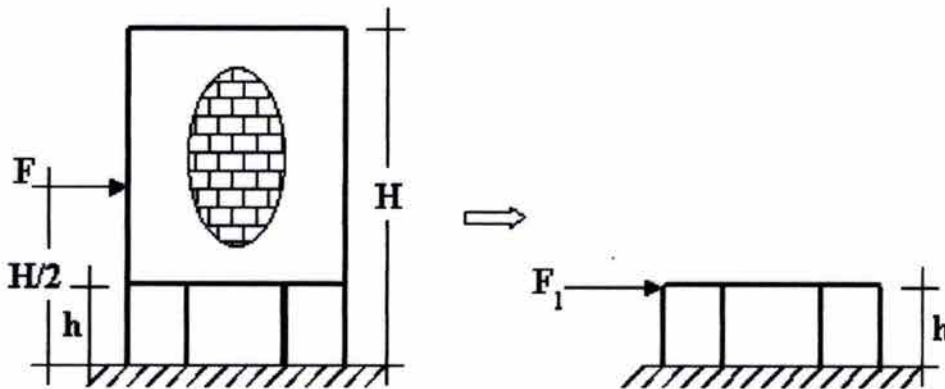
Modelo supuesto para el análisis de la Planta Baja.
